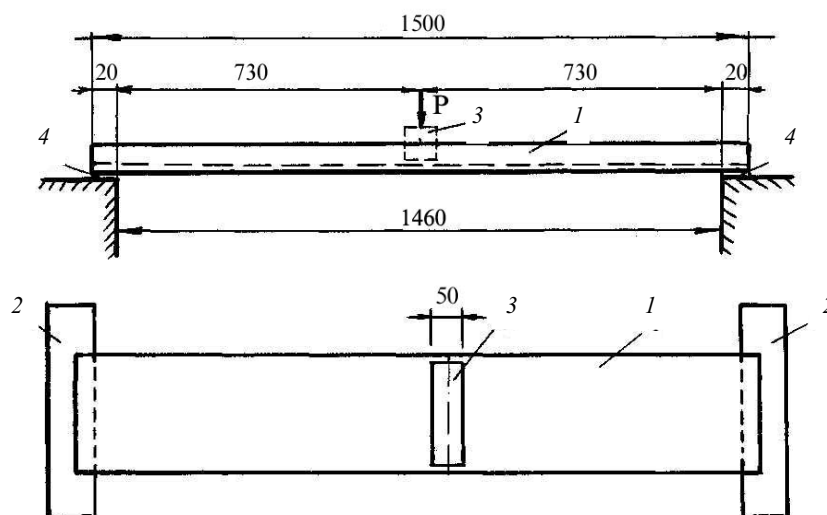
Схема испытания профильного стекла на поперечный изгиб:
